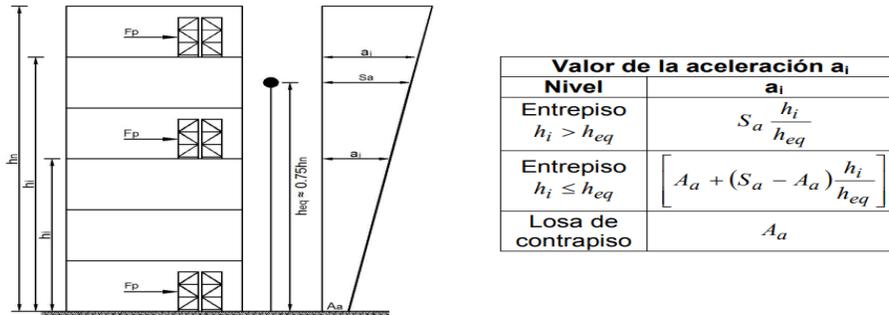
Fuerzas de diseño para estanterías apoyadas en losas de contra piso y losa de entre piso según la NSR-10.
